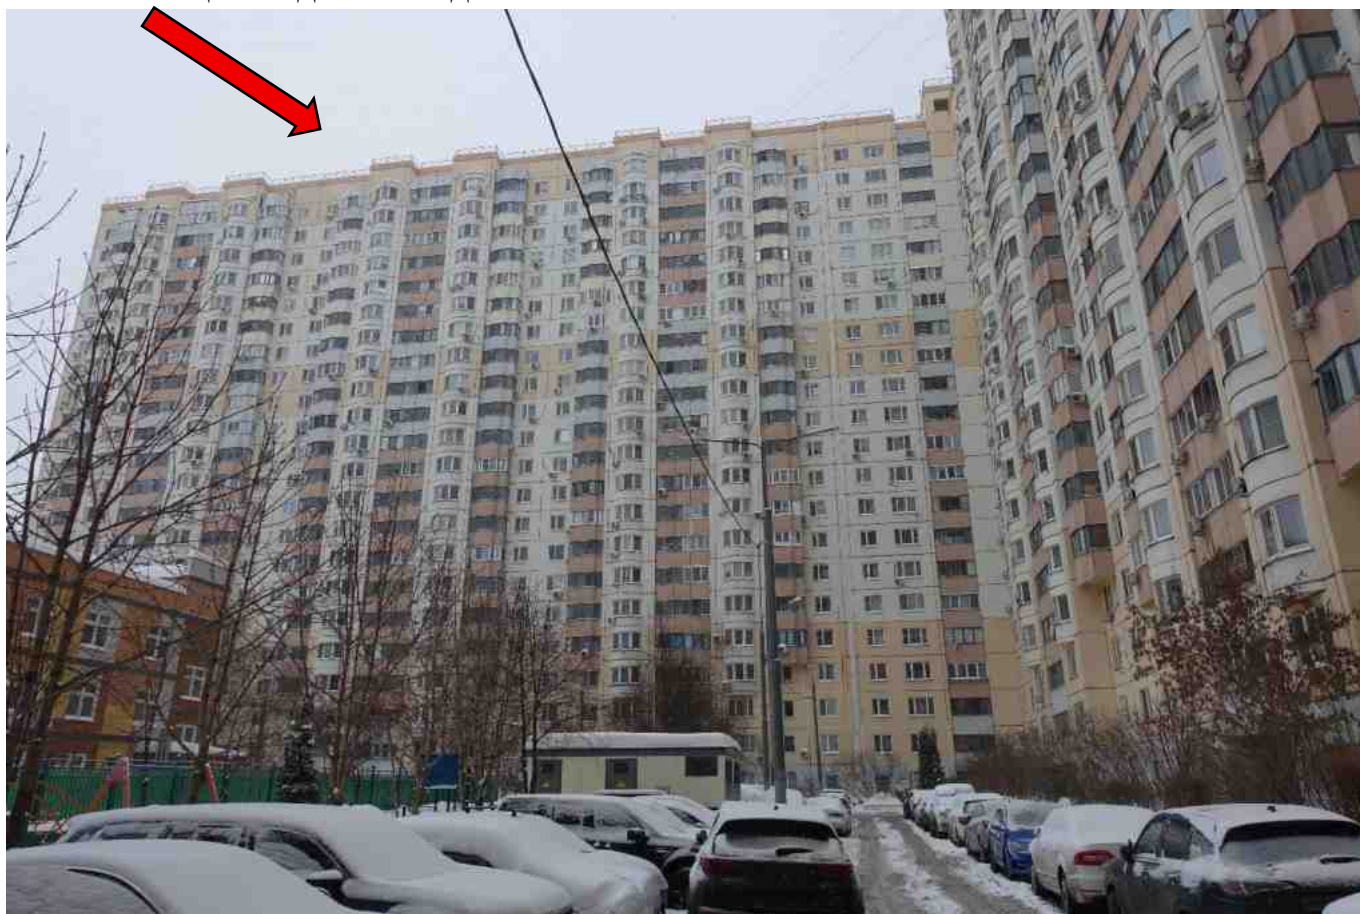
Общий вид жилого дома в/о 8/Ж-Г
